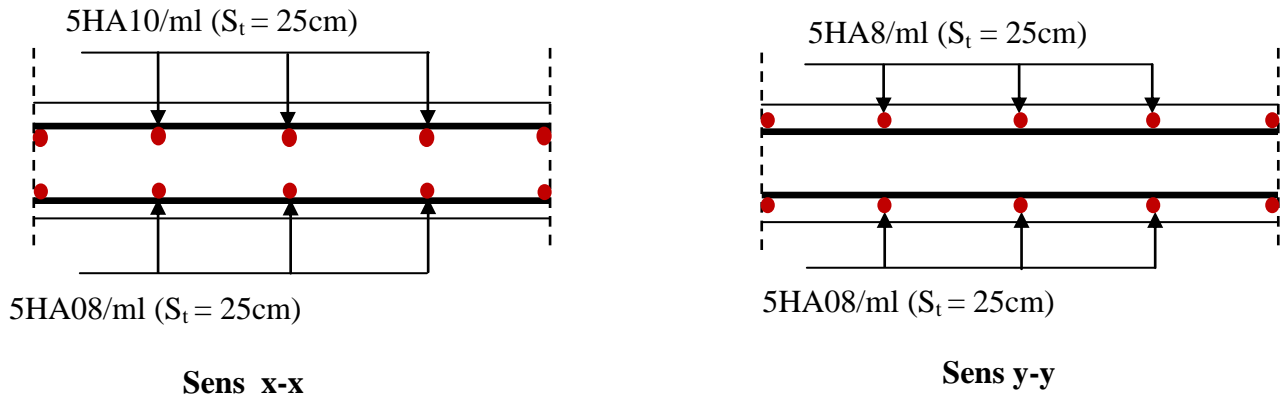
Ferrailage de la dalle pleine de la salle machine.
